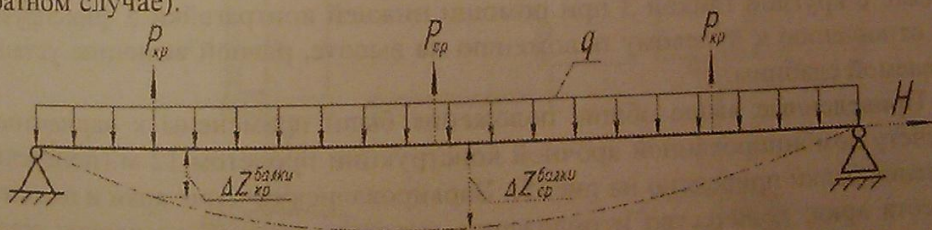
Расчетная схема к определению перемещения точек крепления подвесок к балке
